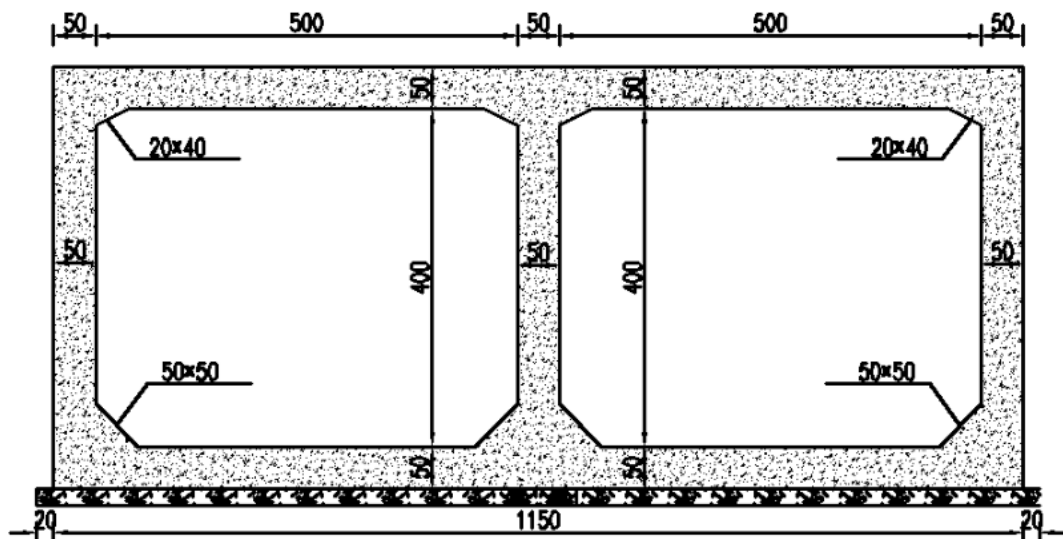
拟建 K0+920 涵洞断面示意图
